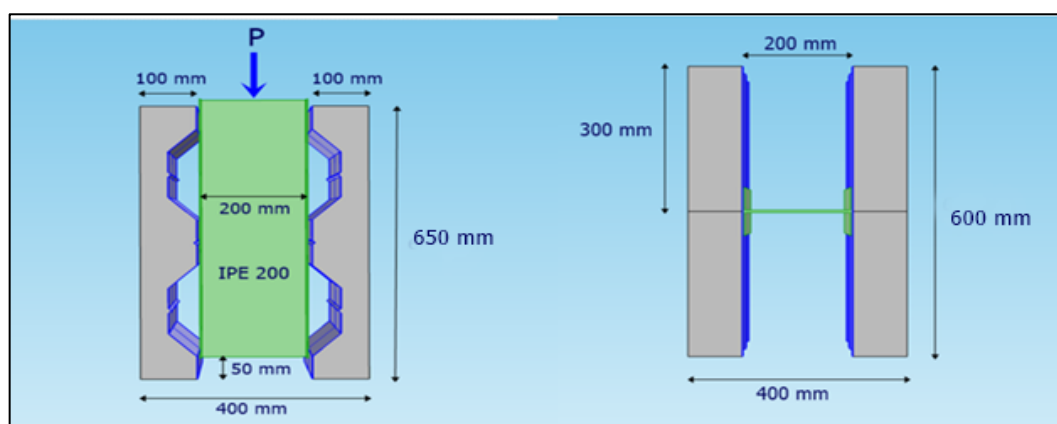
Vista perfil (izq.) y vista en planta (der.) de probetas. Fuente: Autor.
